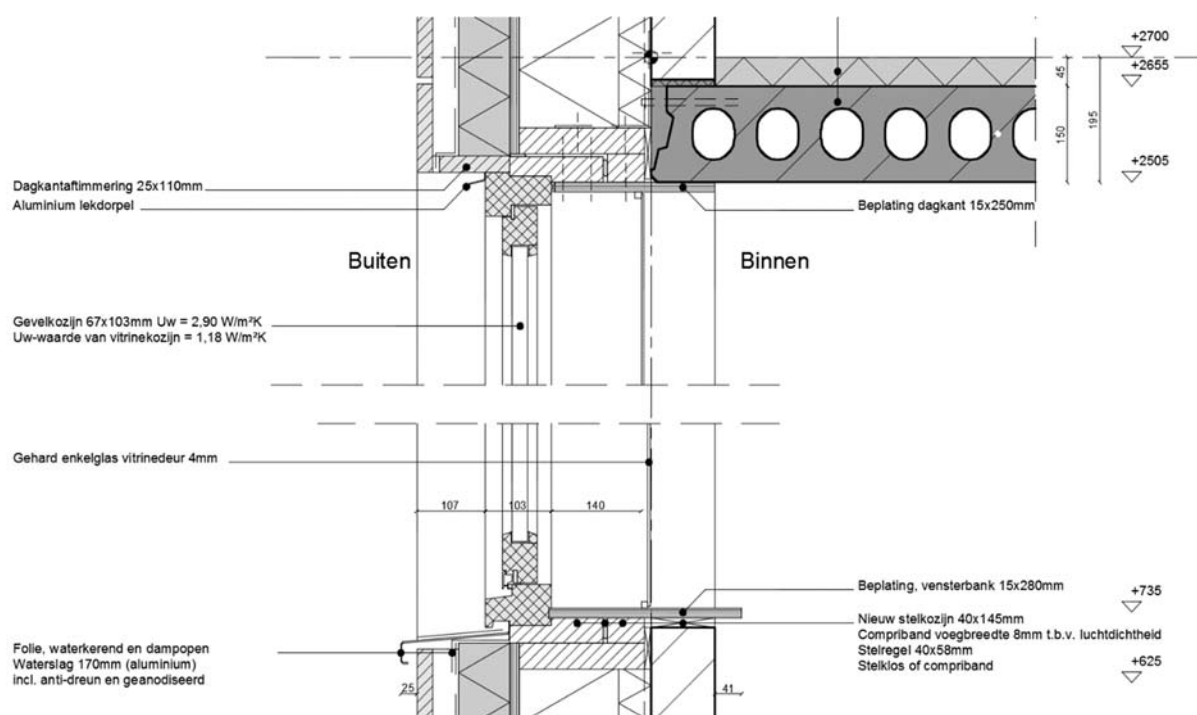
Fragment detailblad 1, bestaande situatie Achterdonk 60, kozijnaansluitingen
